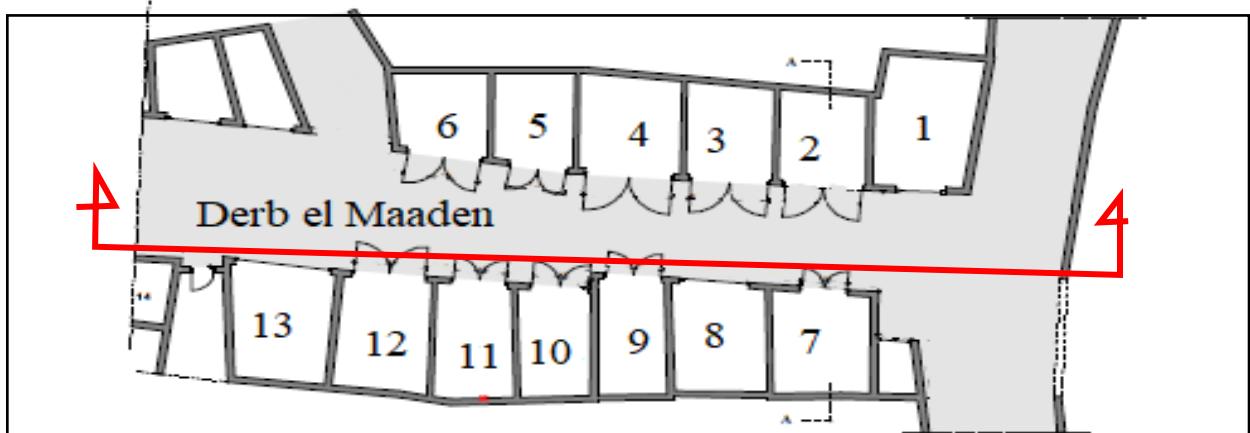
plan (levée) des boutiques et de Rue Derb el Maaden
